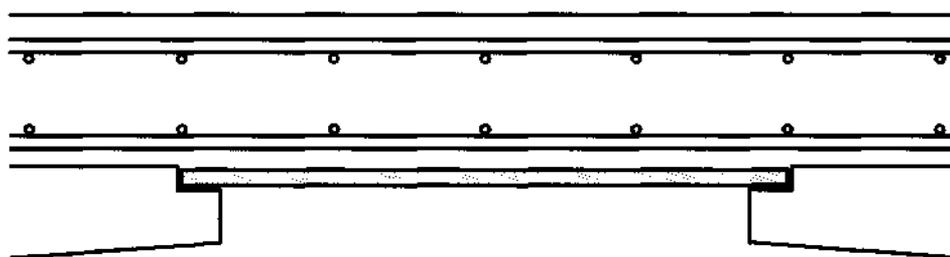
Ferrailage du hourdis sur coffrages perdus
